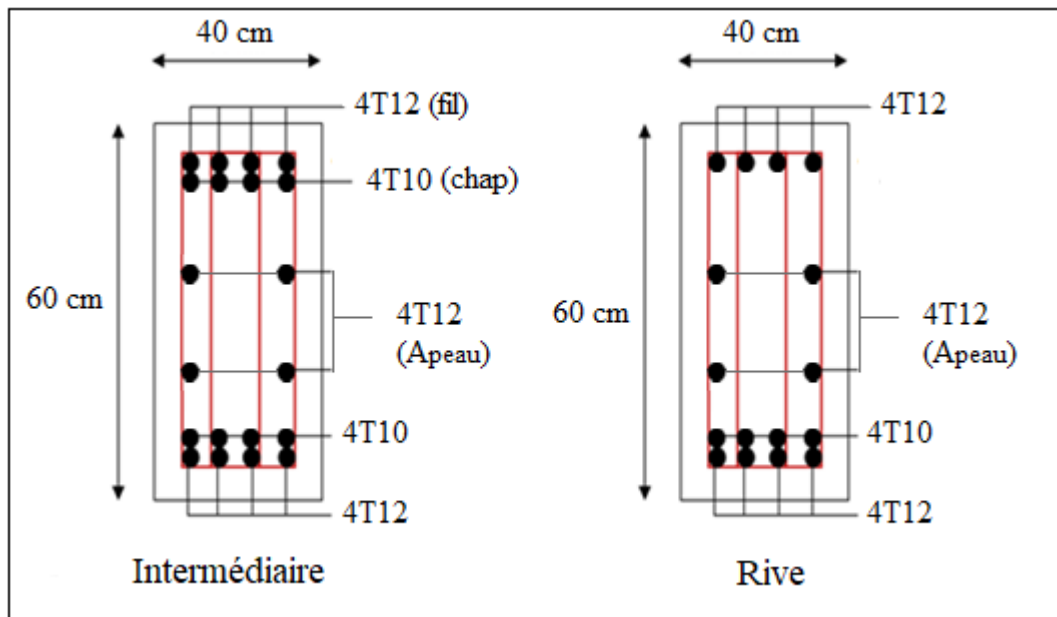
Ferrailage de la poutre de libage suivant le sens transversale.
